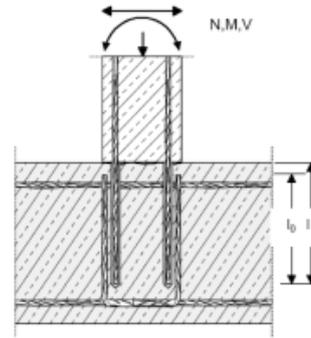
giunzione per sovrapposizione di pilastri sollecitati a flessione o muri a fondazioni.
